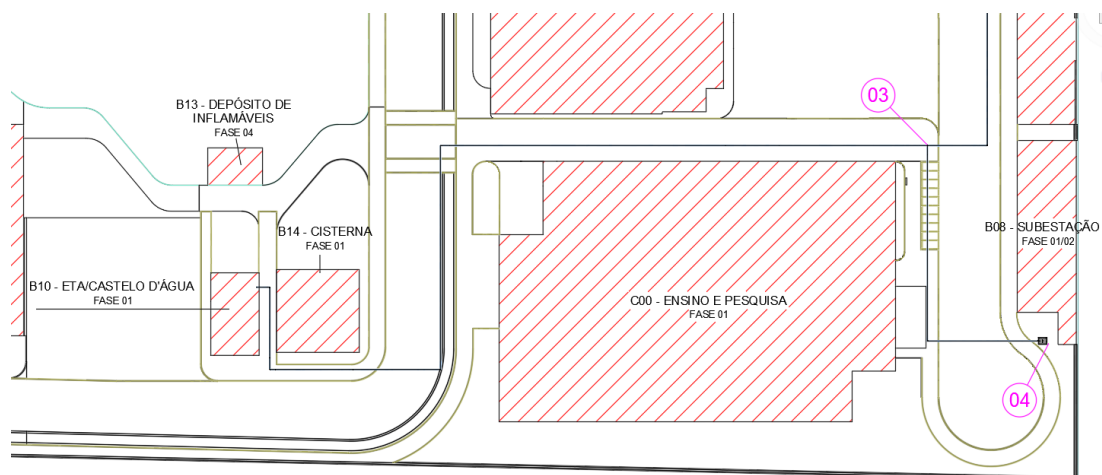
Planta trecho (Castelo d'água / Bloco B08)
